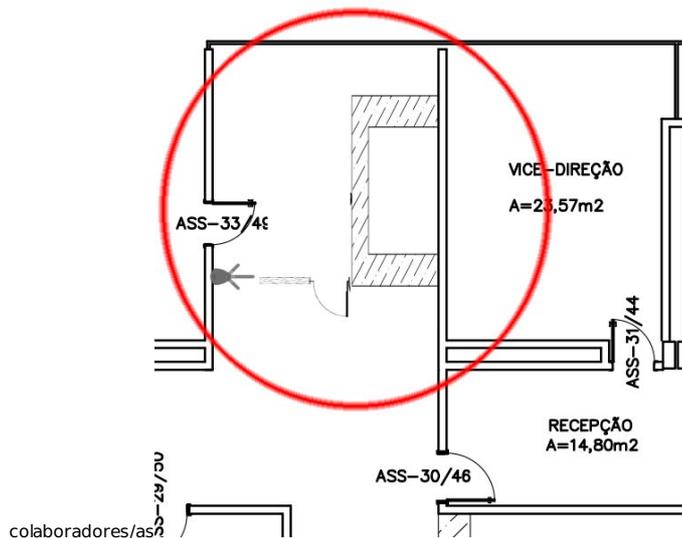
Planta baixa da Biblioteca Central, primeiro subsolo: entrada de serviço para
